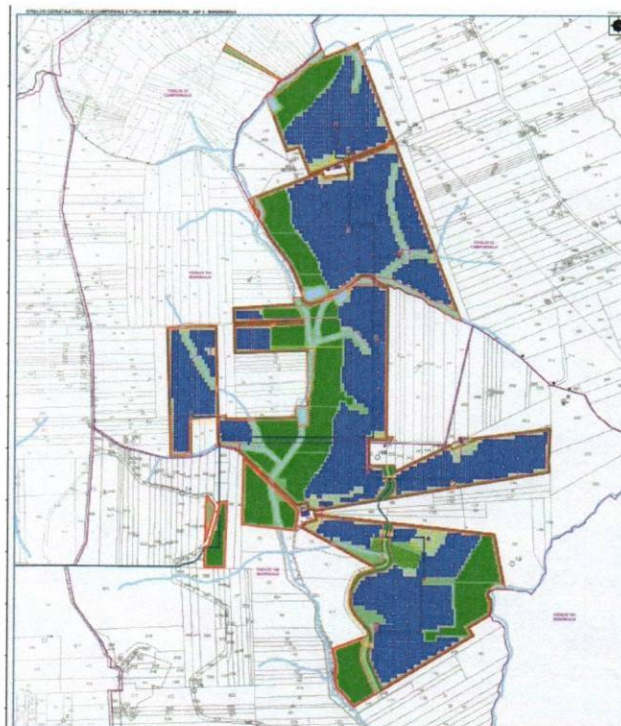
Elaborato di progetto “Nuovo layout Mandranova”
